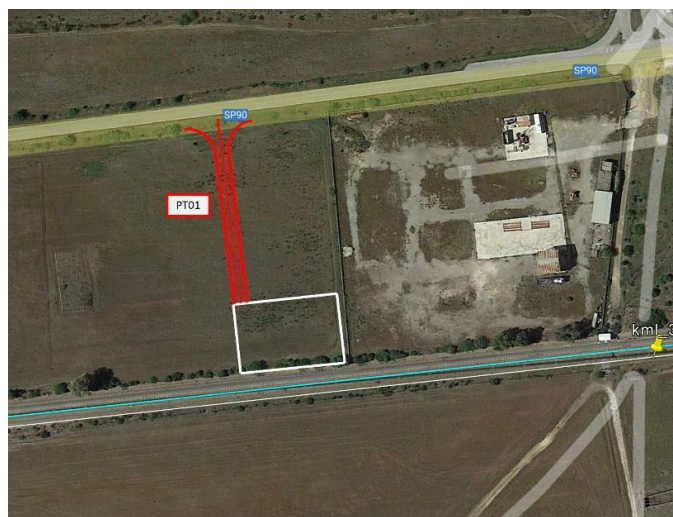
Planimetria PT01 (da RR0P00F16RGEF0005001A).
